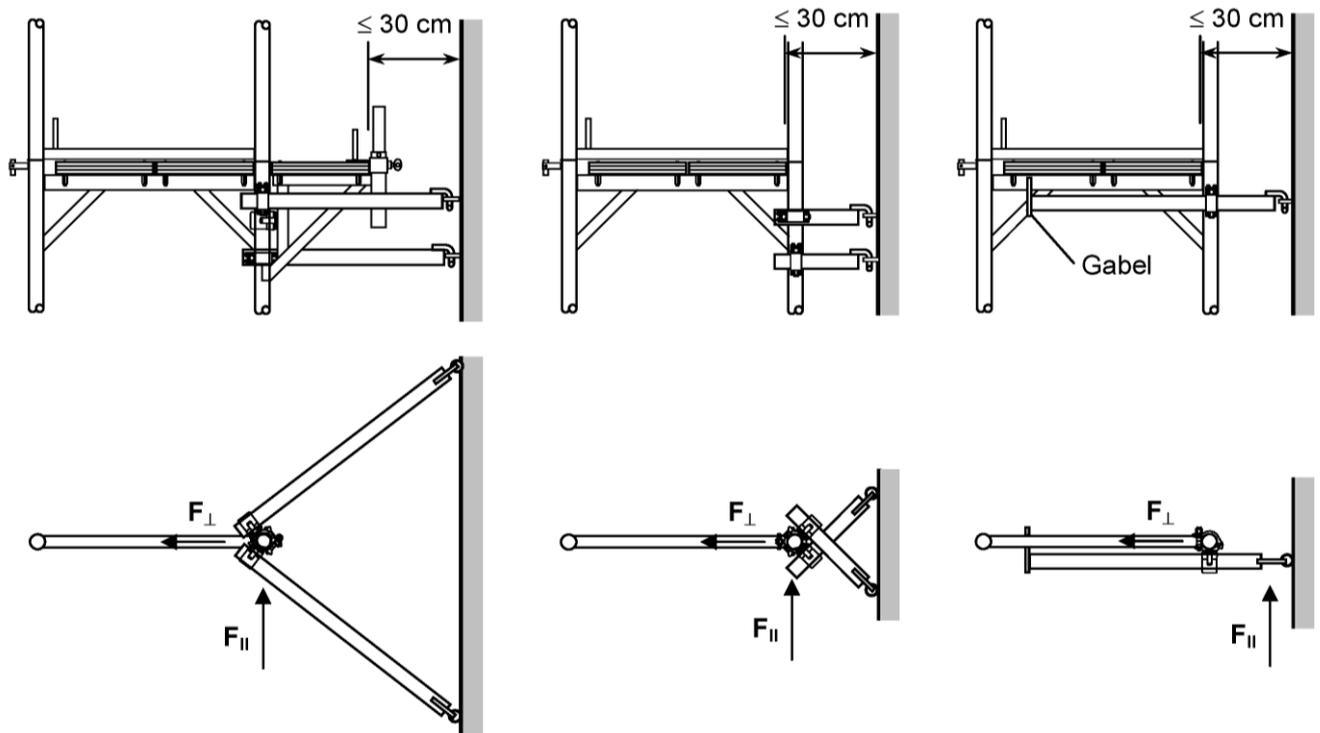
Höhenlage der Gerüsthalter bei Anschluss im „Knoten“
